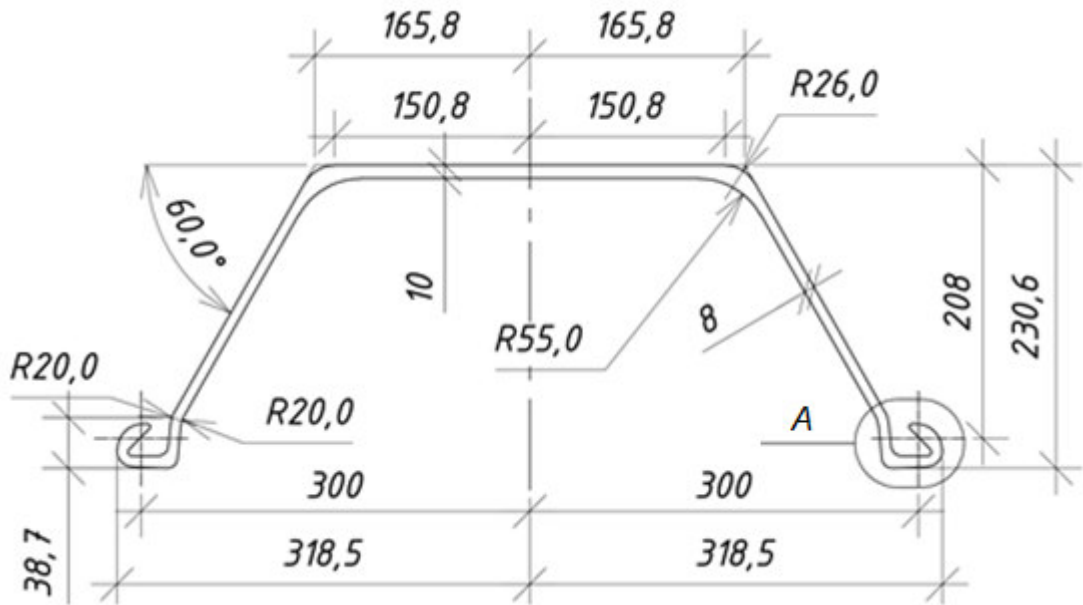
Конструкция шпунта Л6-13НТ
